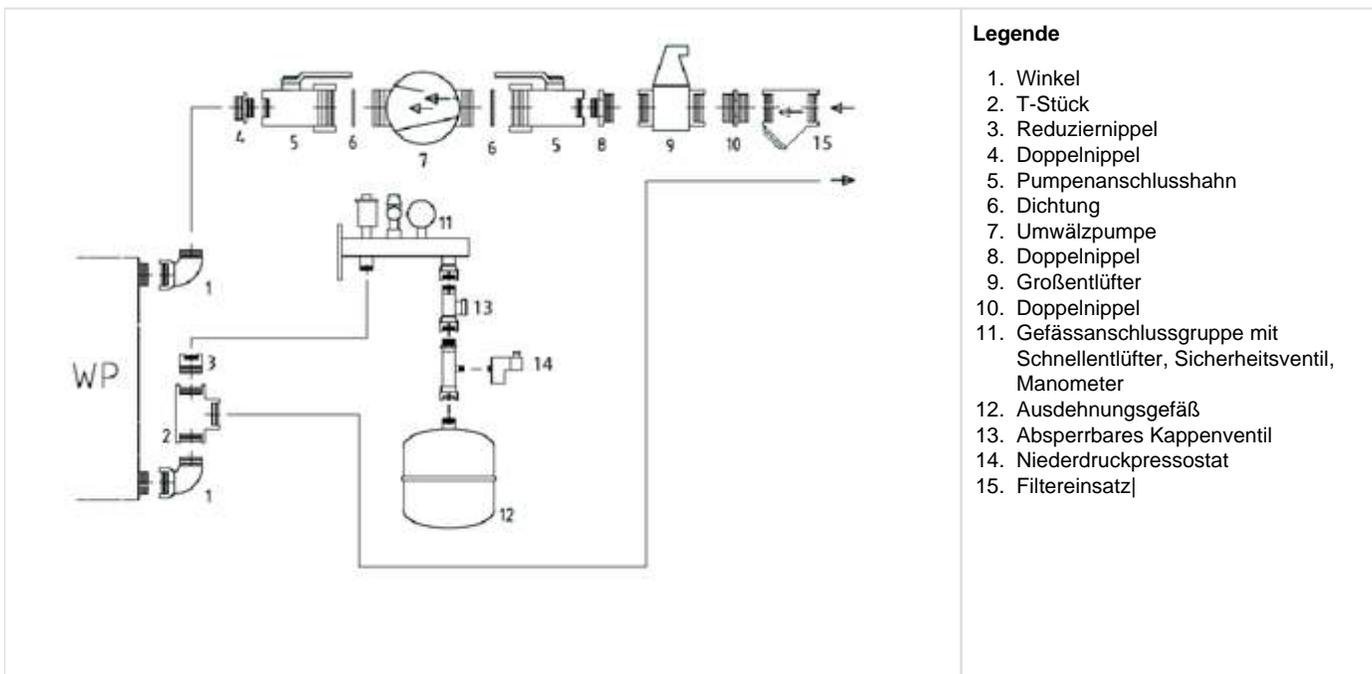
Aufbau Solekreisleitung inkl. Einbauten
